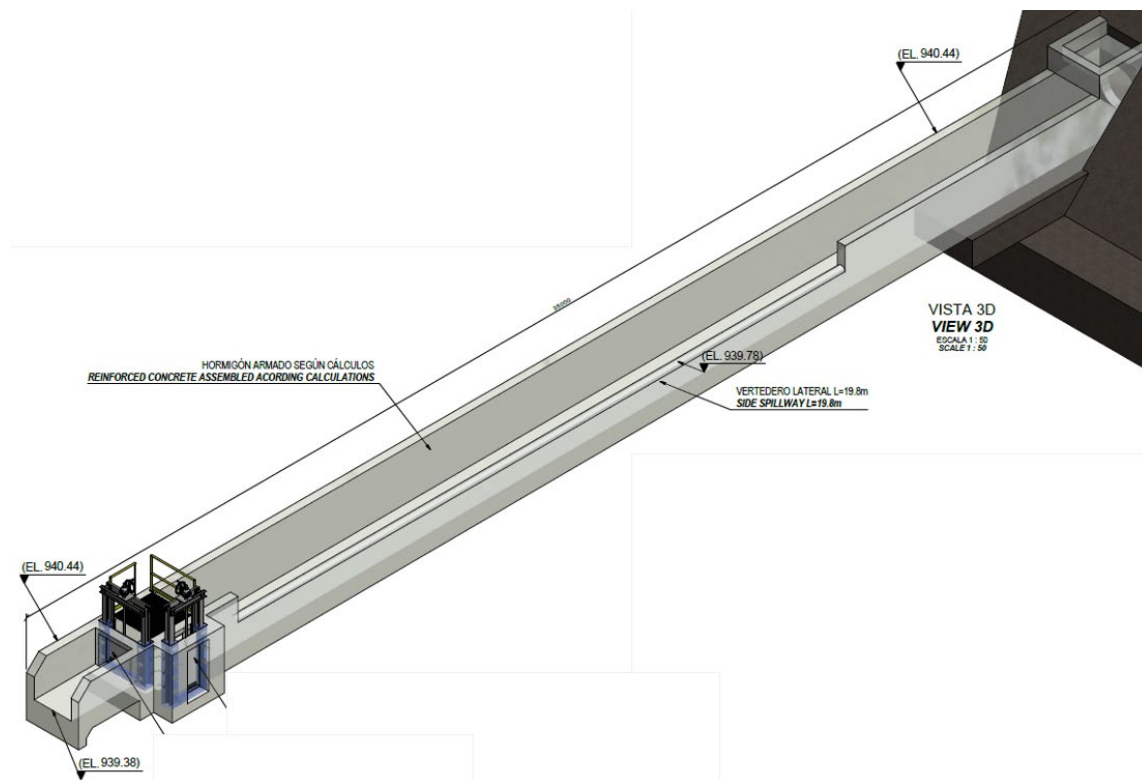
Vista 3D del canal de conexión y vertedero lateral
